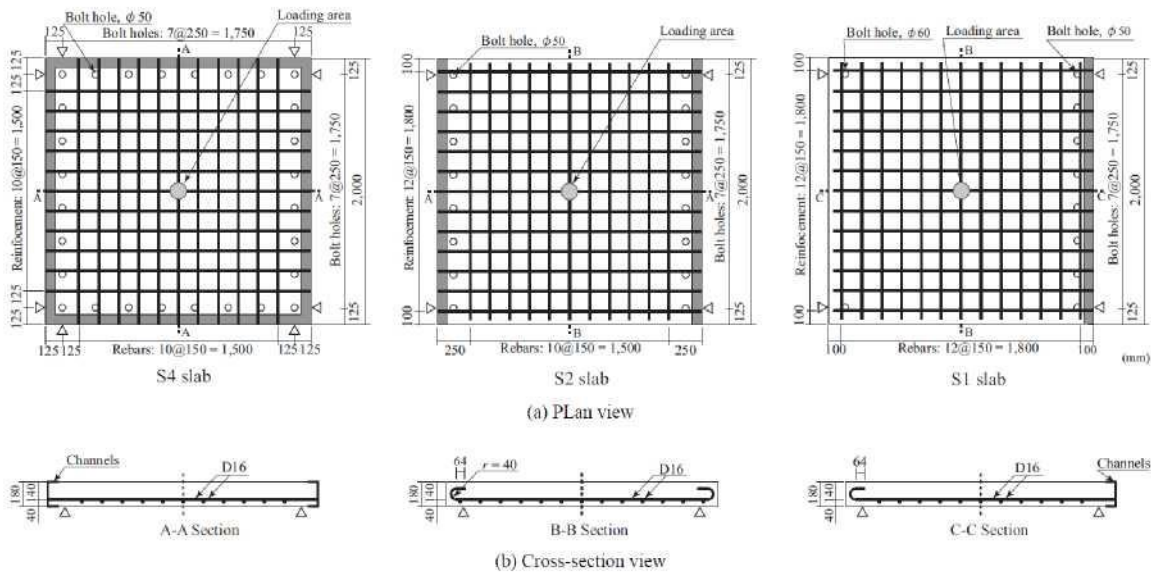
Размеры, схема армирования и условия крепления плит [24]
